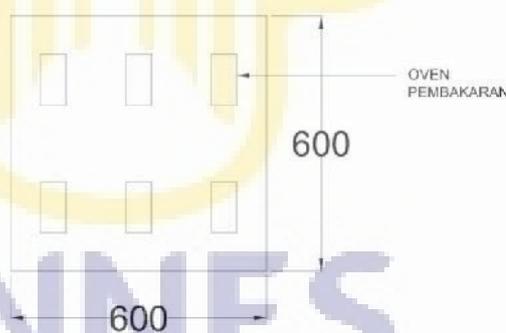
Skema ruang penyimpanan gerabah mentah jadi
